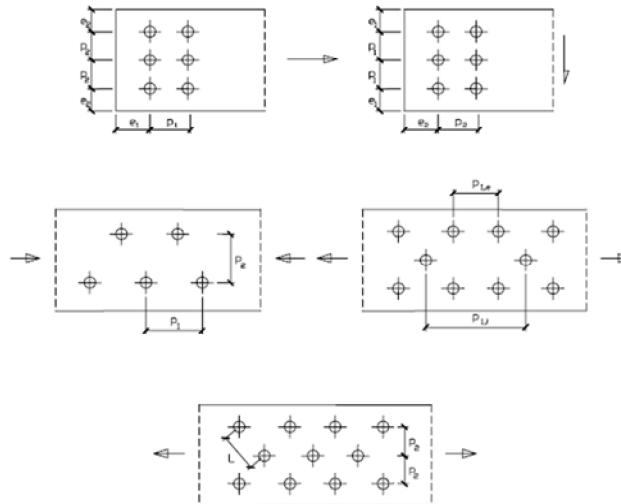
Principales disposiciones constructivas de una unión atornillada [22].
